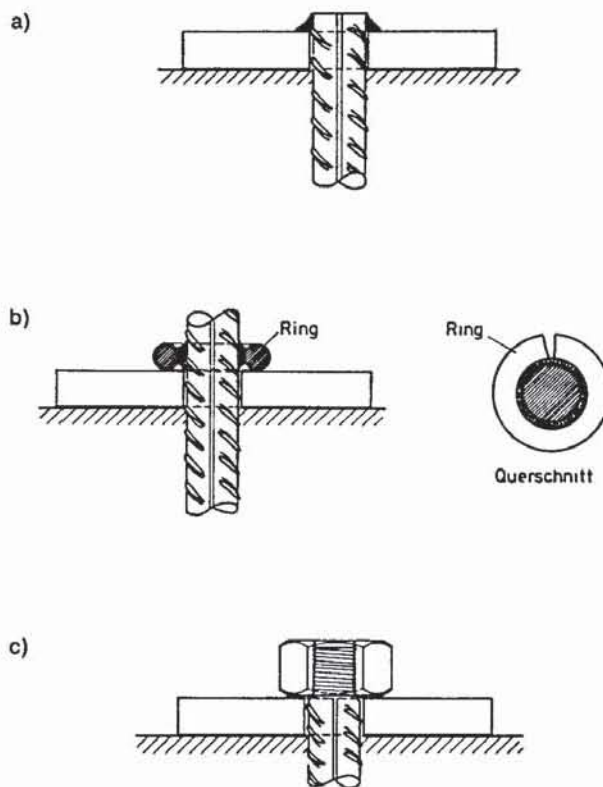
Beispiele für Ankerkörper: a) Bewehrungsstab mittels Kehlnaht an der Außenseite der Ankerplatte angeschweißt – b) Bewehrungsstab mittels aufgeschweißtem Ring gegen die Ankerplatte abgestützt – c) Bewehrungsstab mittels Gewinde gegen die Ankerplatte verschraubt.
